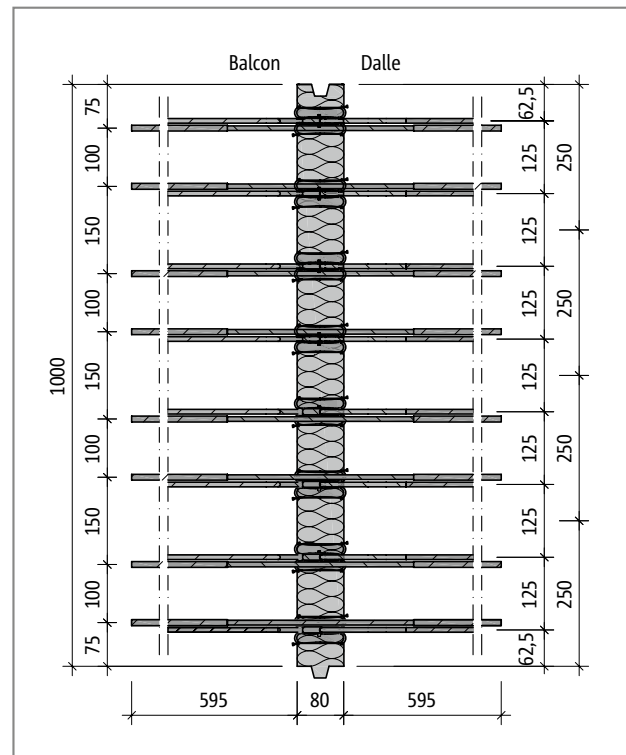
Schöck Isokorb® Type K-E-M4 : Plan de base du produit
